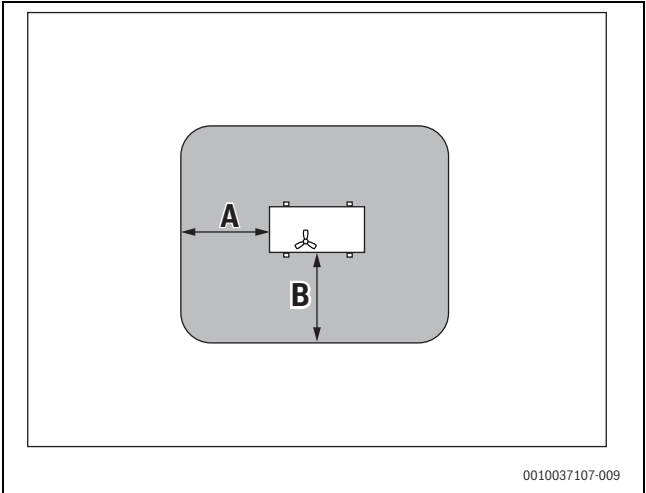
Zone de sécurité, installation au sol sur un terrain ou un toit
